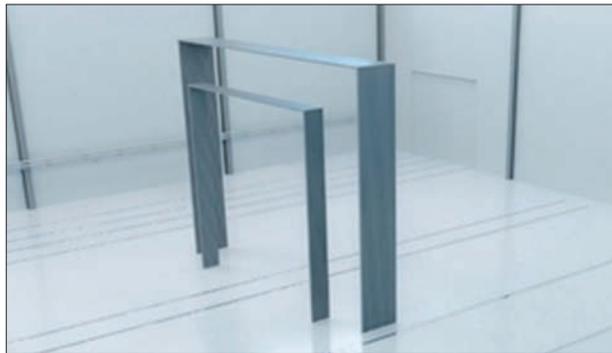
Сборка секций и стыковка их в общий несущий каркас
